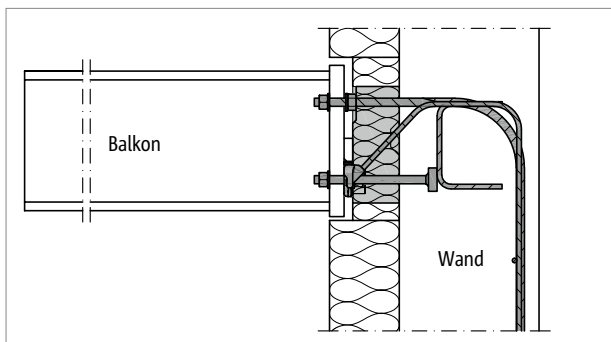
Schöck Isokorf® T type SK: aansluiting aan de vloer van gewapend beton
